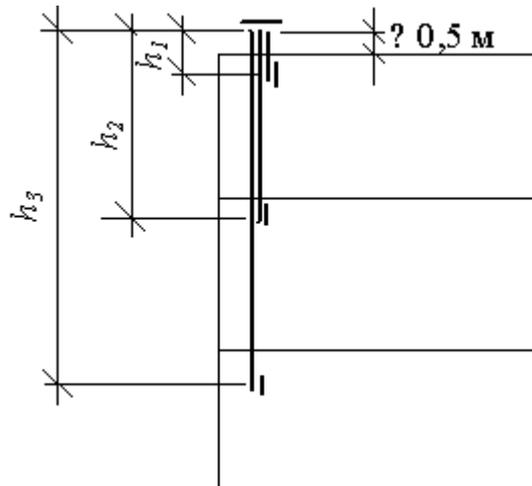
Схема системы вентиляции в бесчердачных зданиях
